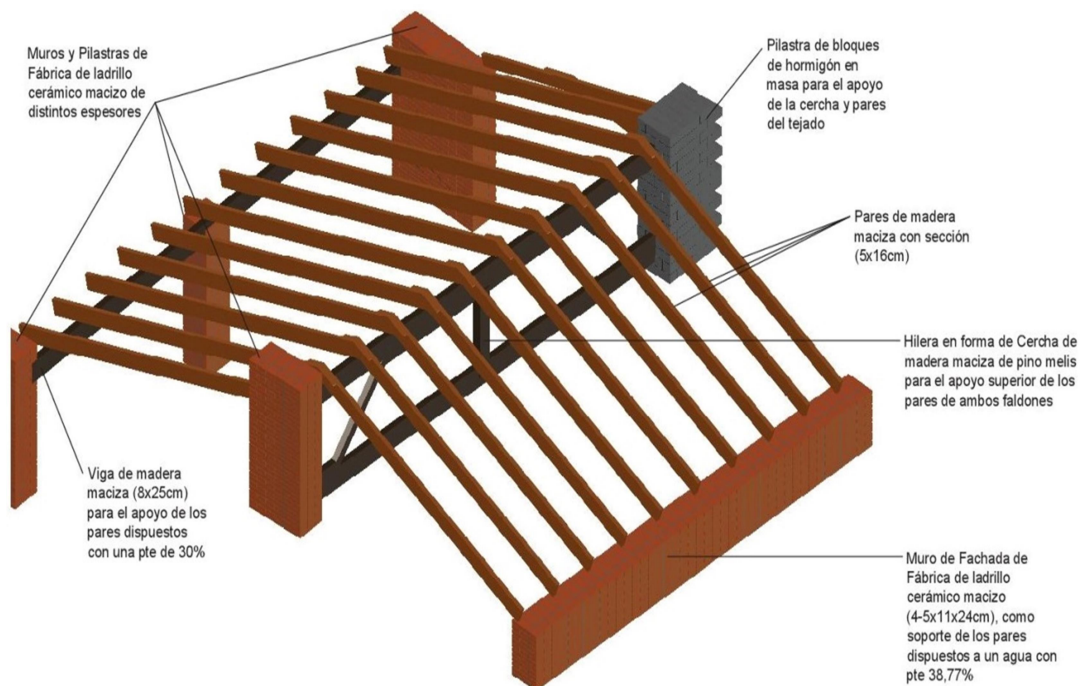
Detalle en Perspectiva de la estructura del Tejado a dos aguas con acabado en teja árabe sobre faldón de cañizo
